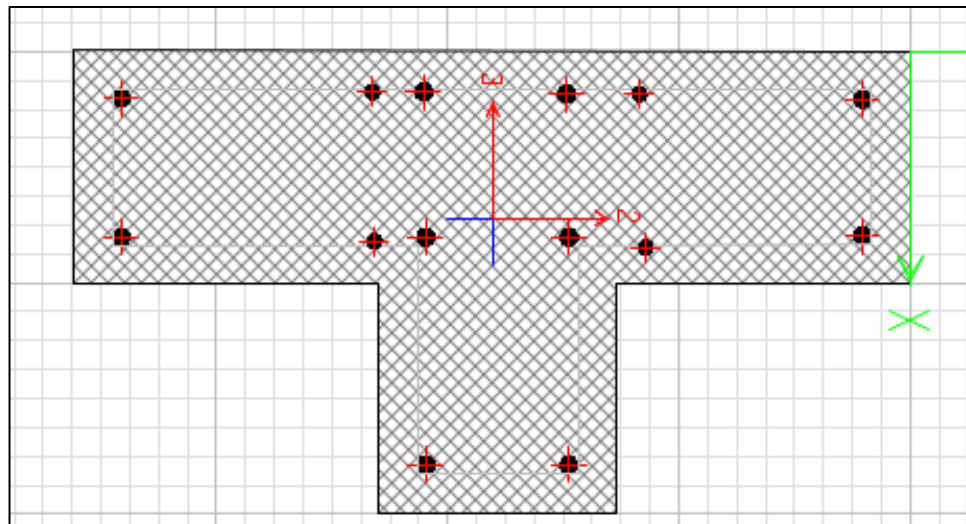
Creación de la sección de la columna 7 en la opción Section Designer.
